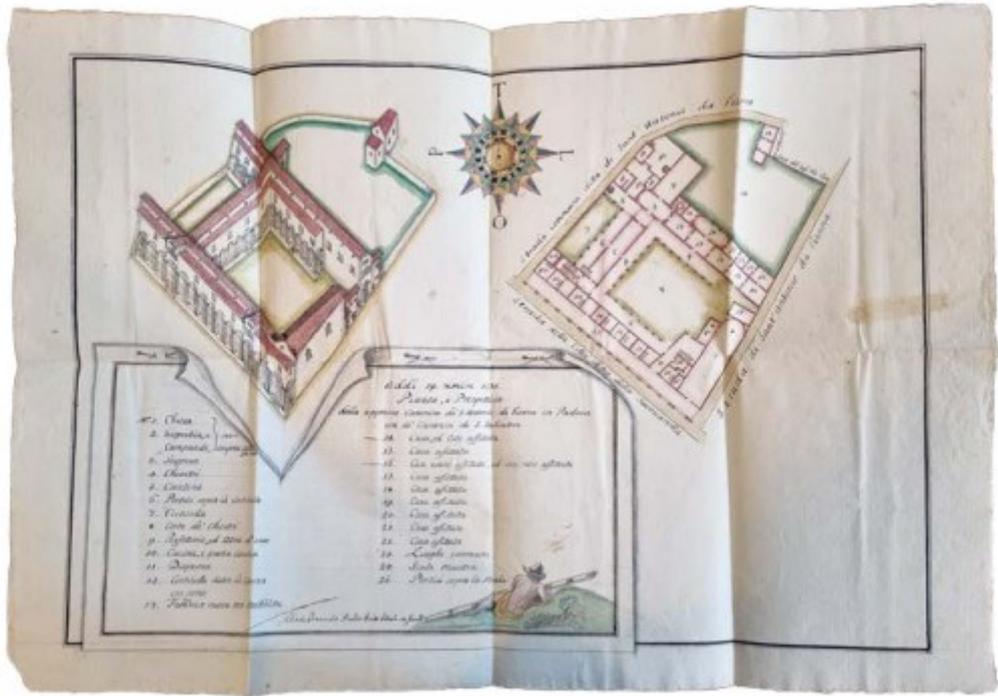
Pianta e prospetto di Alvise Francesco Duodo. Conservata in ASVE, Aggiunto Sopra Monasteri, Atti, b.41, fasc.
